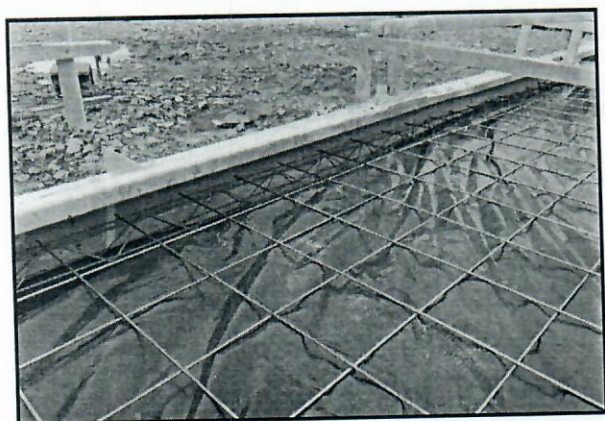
Armadura do radier (treliça e tela soldada)
